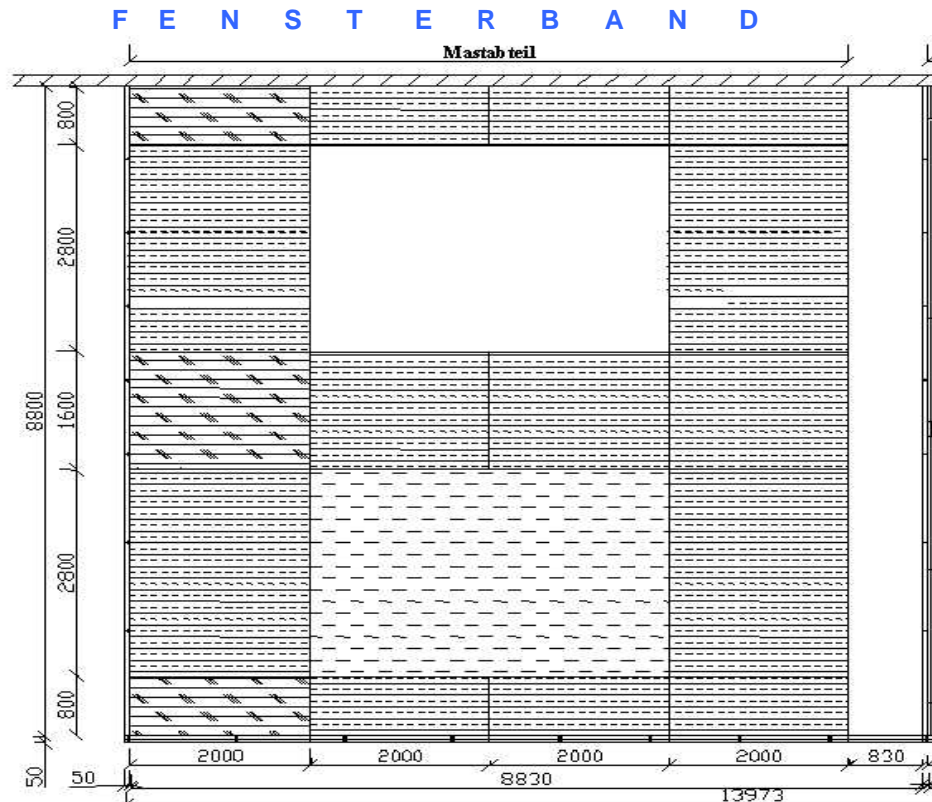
Grundriss des Versuchsabteils zur Schweinemast
